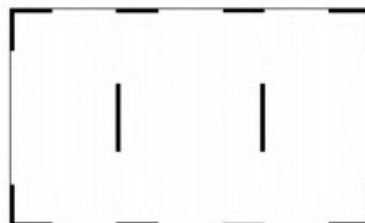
Treillis de contreventement, les murs de contreventements sur plan
